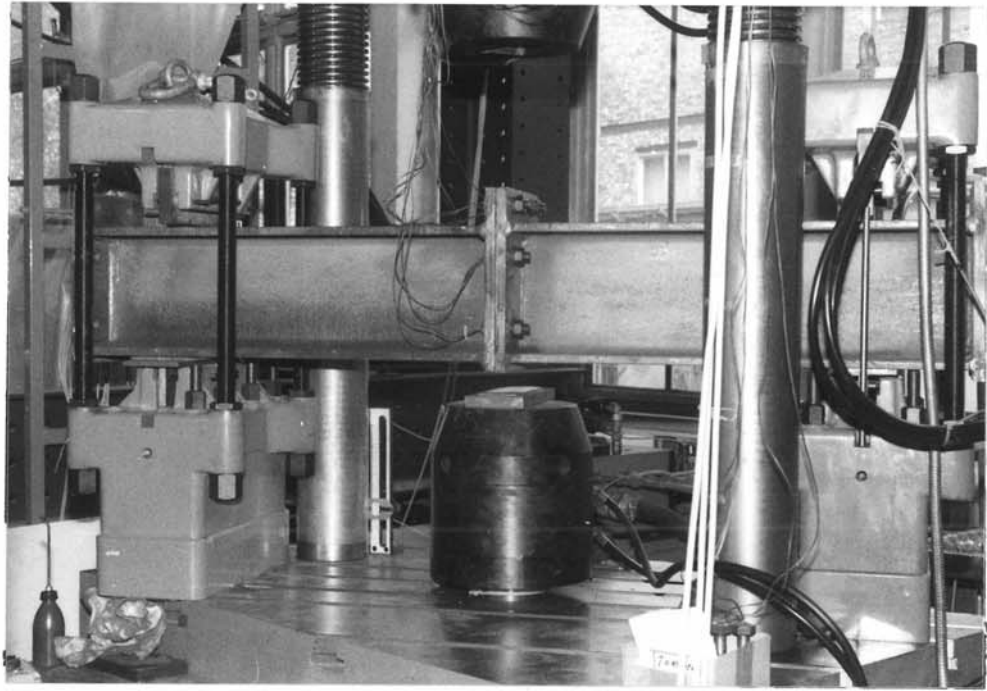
Biegeträger mit Kopfplattenstoß in Prüfmaschine HUS 60. Druckkolben abgesenkt
